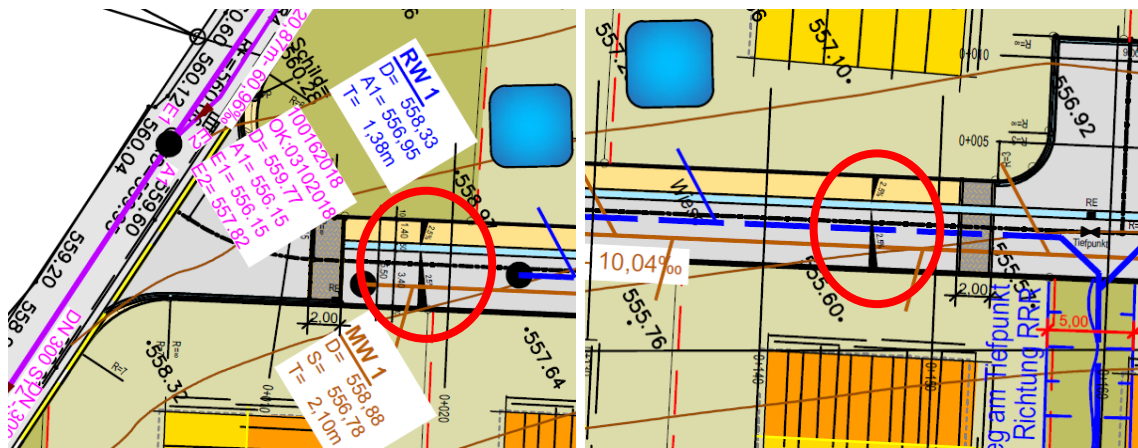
Ausschnitt Entwässerungskonzept: Gefälle Straßenfläche Beginn Erschließungsstraße (links) und Erschließungsstraße Wendehammer (rechts)
